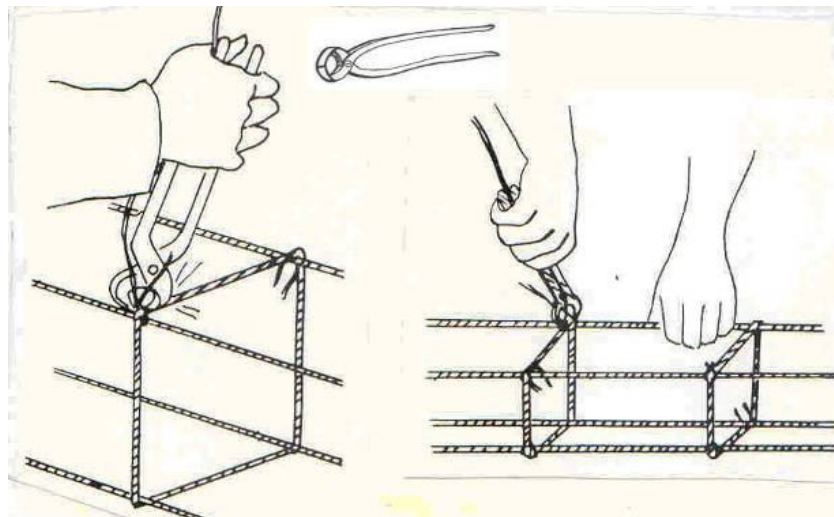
Ilustração da amarração da armadura de uma viga (BOTTURA & MELHADO, 2006)
